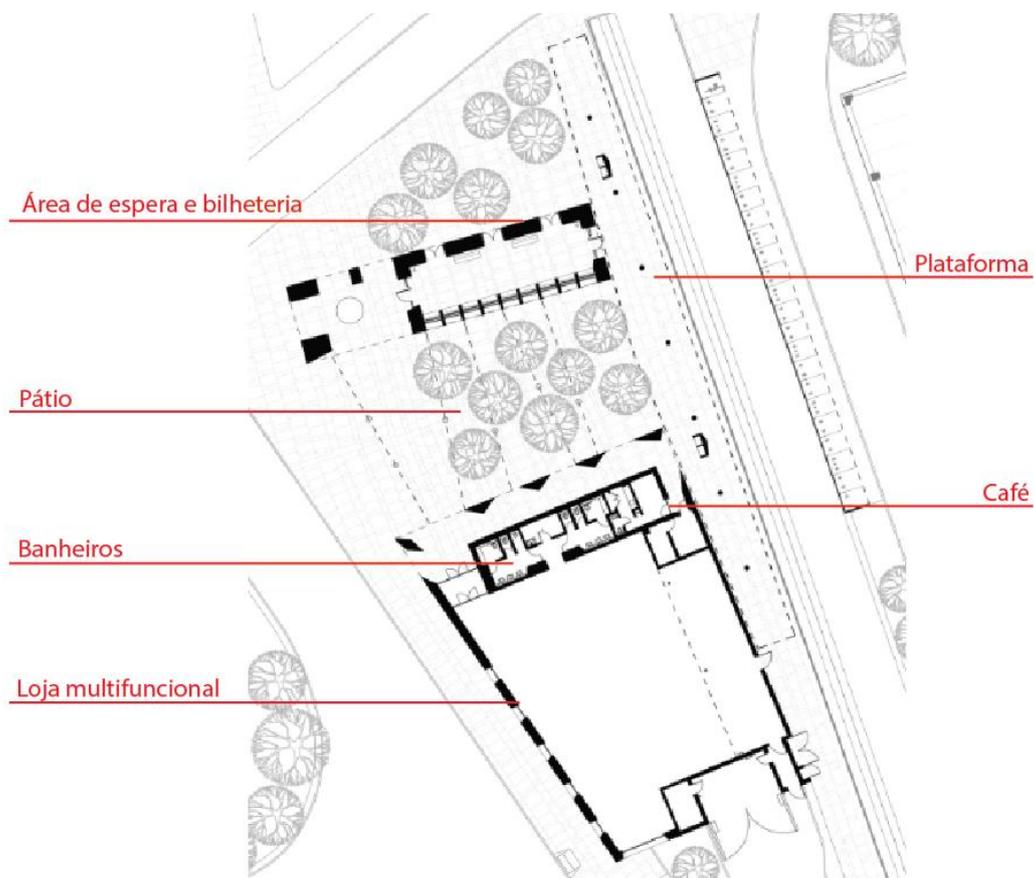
Planta baixa estação de Princeton. Studio Rick Joy. 2018. Disponível em:
